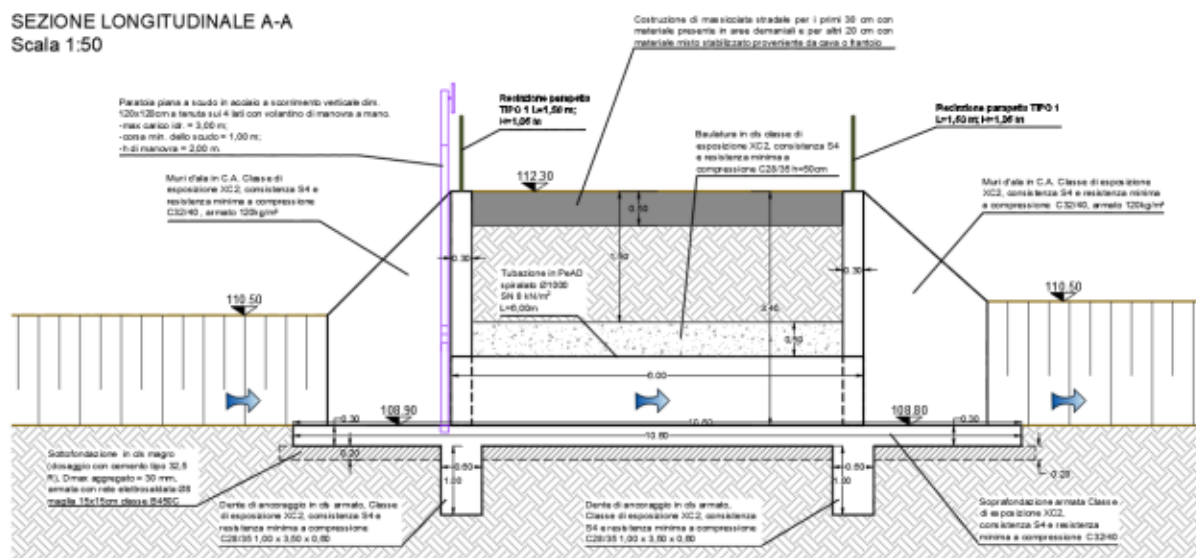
SEZIONE TRASVERSALE DEL MANUFATTO CHIAVICALE IN PROGETTO
